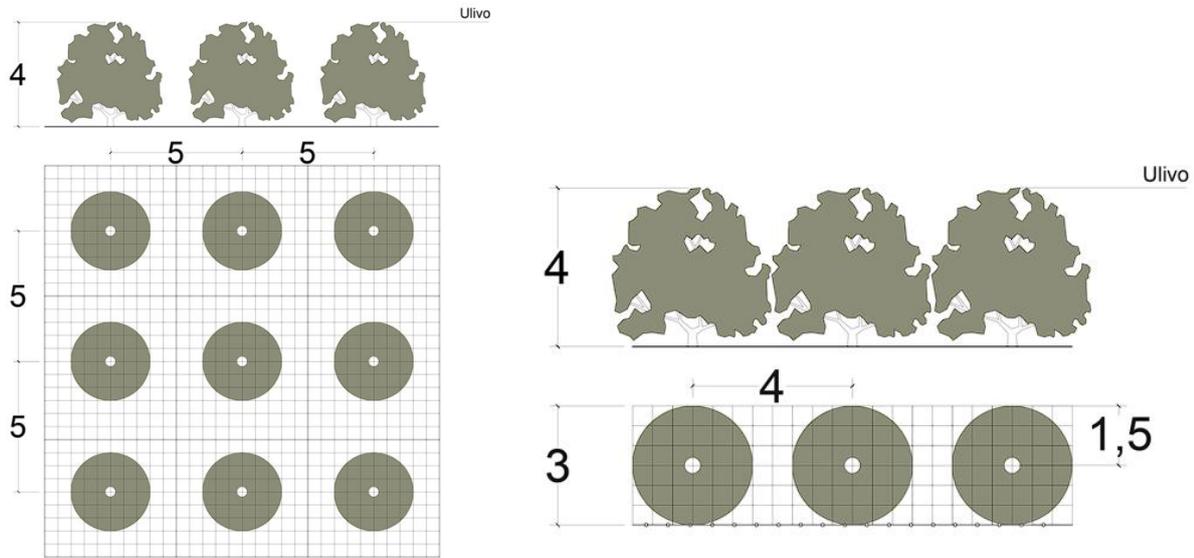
SCHEMA D’IMPIANTO (ESTRATTO DALL’ELABORATO GRAFICO SIL-PDT11)
